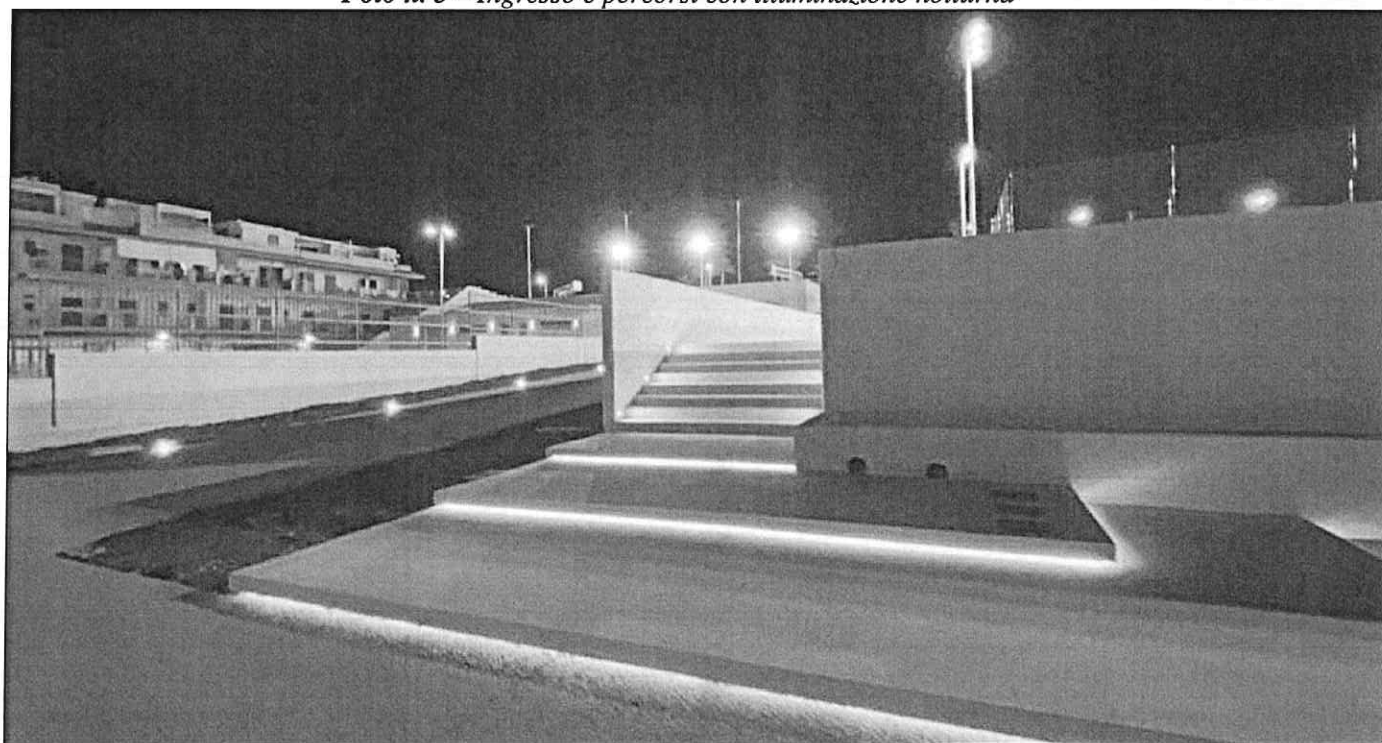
Ingresso e percorsi con illuminazione notturna
